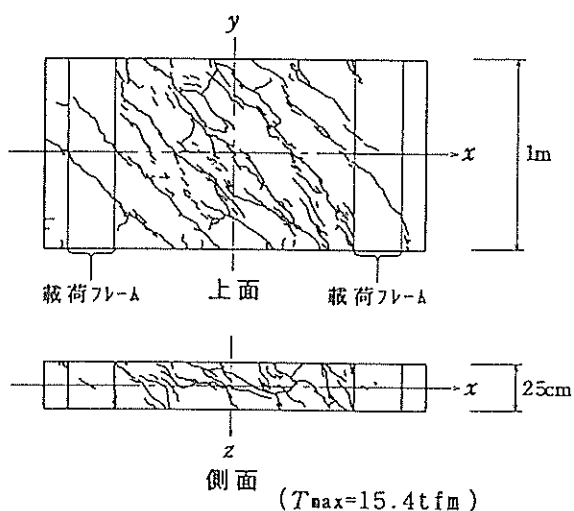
供試体 RC-19-150のひび割れ発生位置
